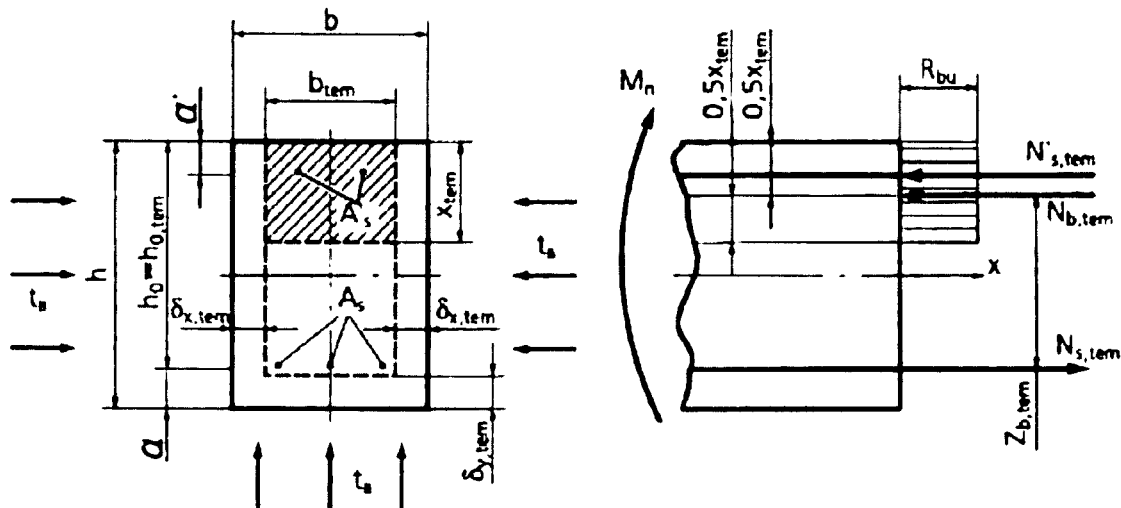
Расчетная схема железобетонной балки прямоугольного сечения
